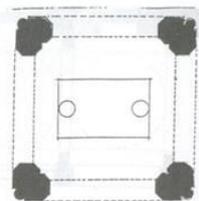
مسقط أفقي لبقعة الشيخ الرويني بالفيوم (عن إبراهيم عامر) -
